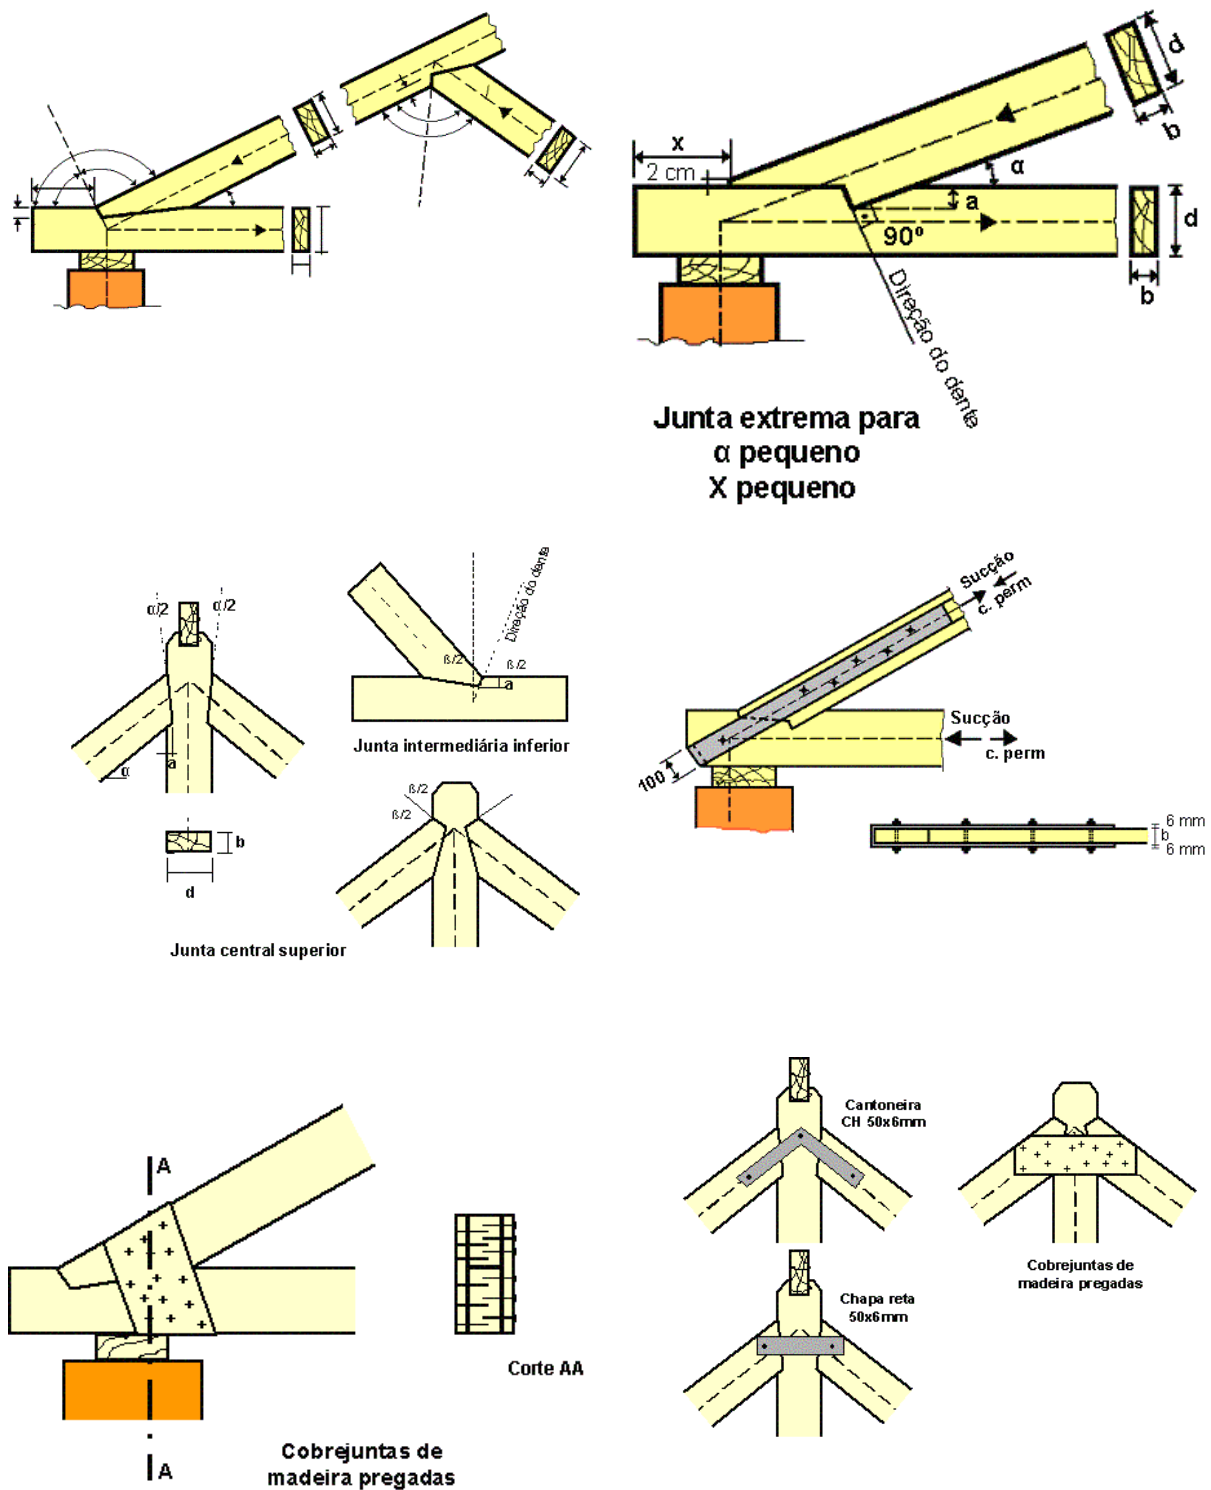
Detalhes de ligações da estrutura de madeira – sambladuras e emendas.
